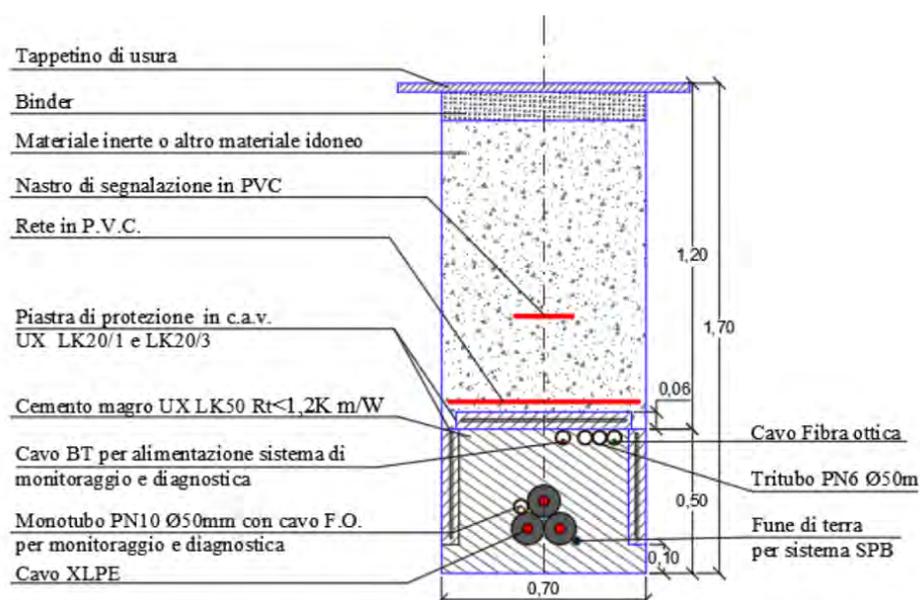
Sezione di posa cavidotto AT su Strada Asfaltata
